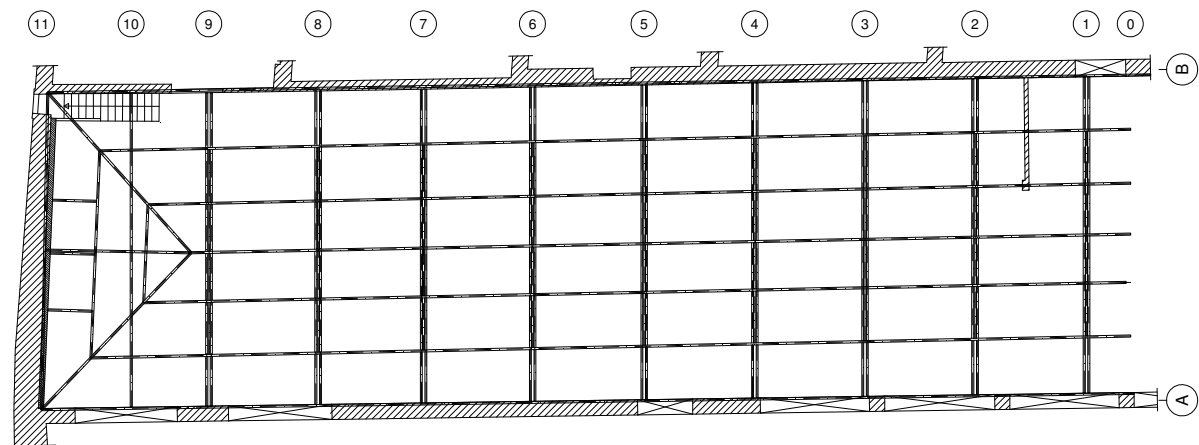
Planta estrutural da cobertura do armazém F (sem escala).
